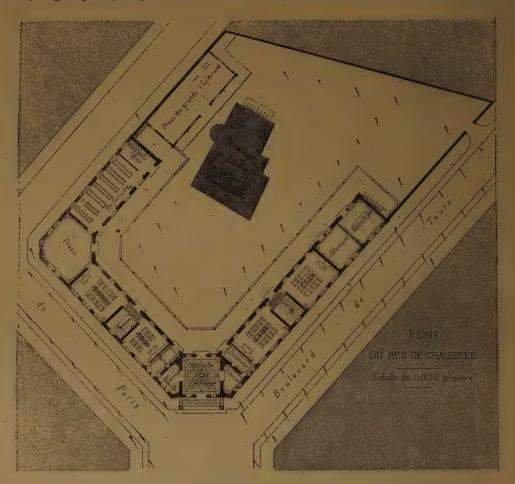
Petit lycée de Laval, plan du rez-de-chaussée. — Échelle de 0^m,00125 par mètre.
